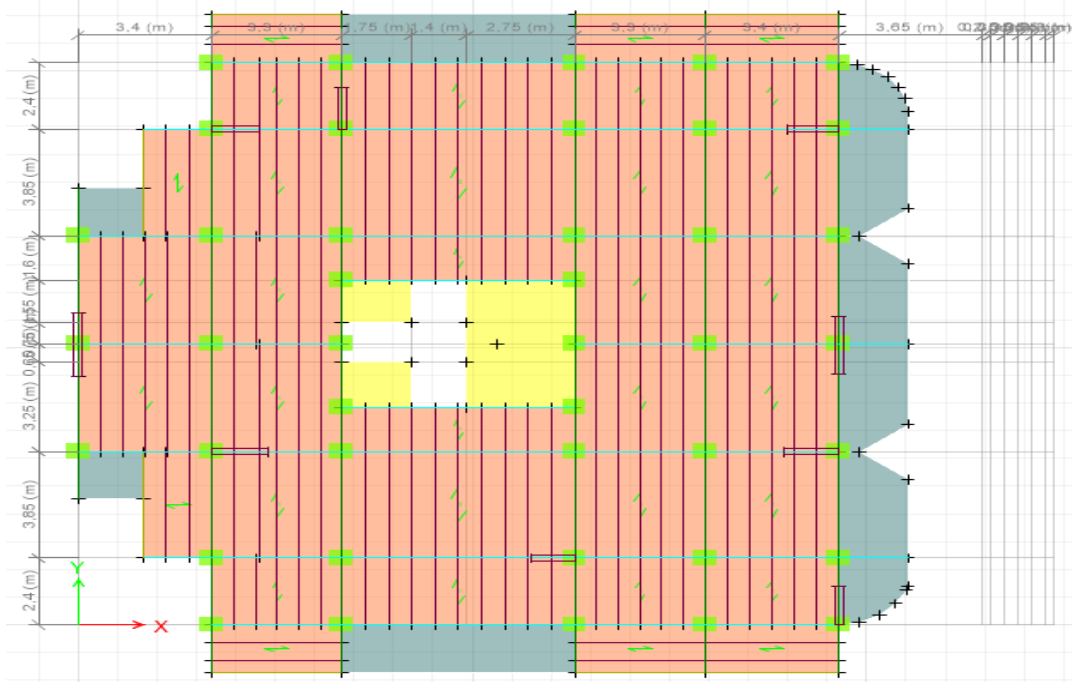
Plan de disposition des voiles (3^{ème} étage).
